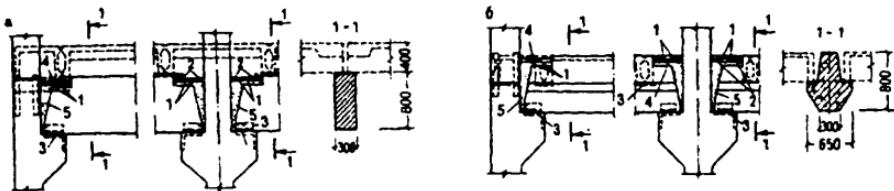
Узлы сопряжения элементов каркаса многоэтажных зданий:
